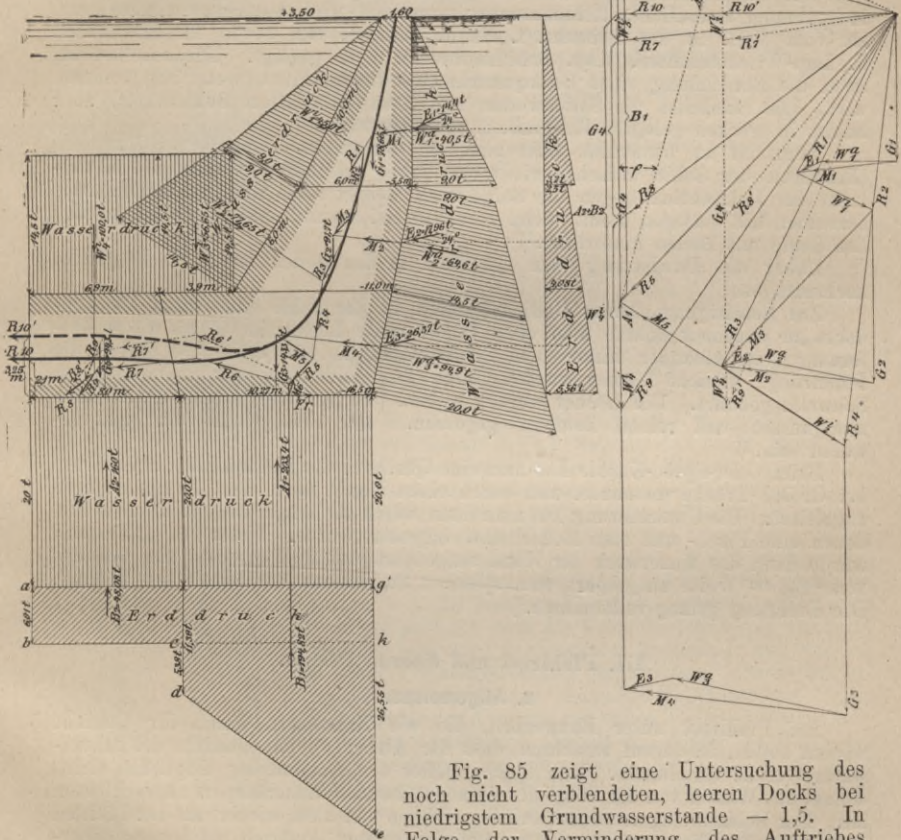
zeigt eine Untersuchung des noch nicht verblendeten, leeren Docks bei niedrigstem Grundwasserstande — 1,5. In Folge der Verminderung des Auftriebes ergibt sich hier ein grösserer Werth von B_1 .
